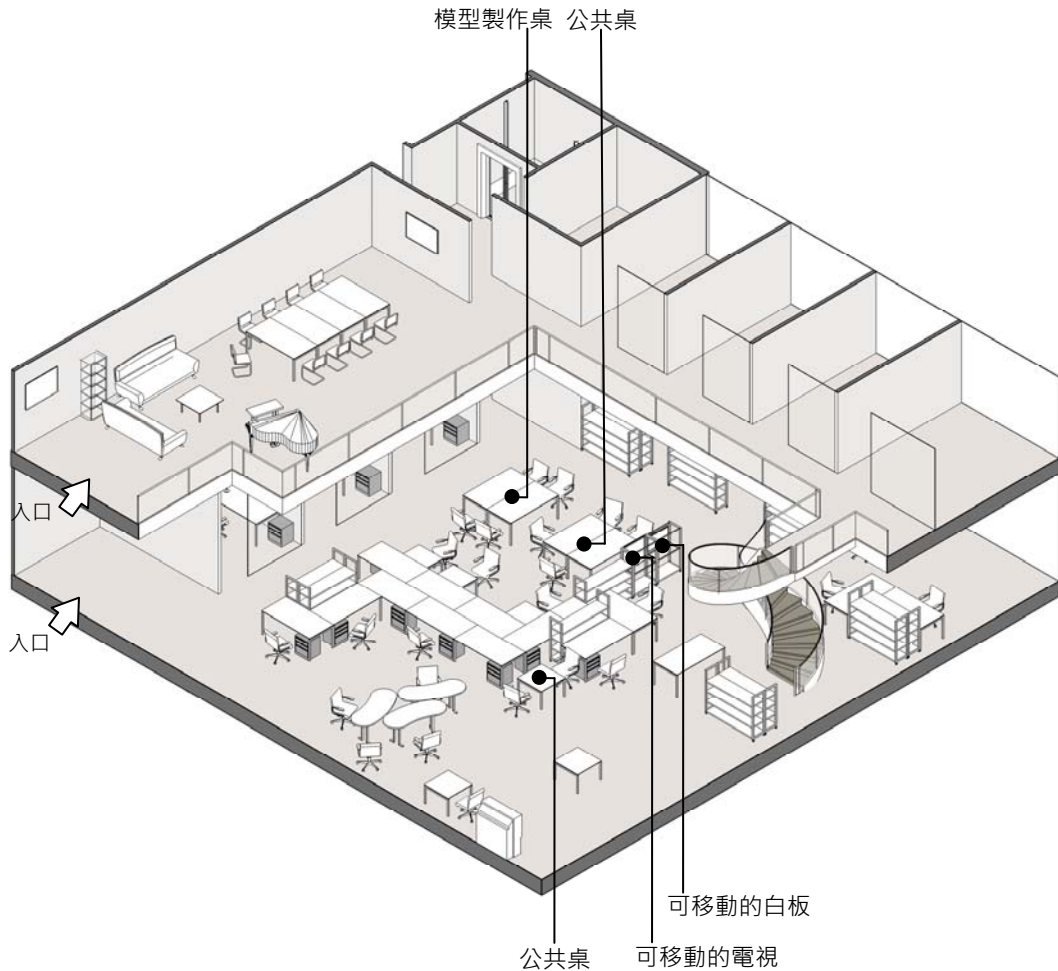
Media Lab Swatch Lab 工作站平面配置
